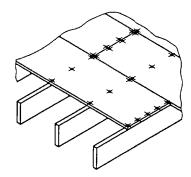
Конструкційне монтування крайок з гребенем та пазом, що укладають поперек короткими крайками та утримують на балках
